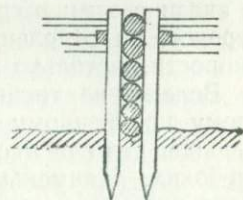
Поперечный разрез буна из кольев с фашинами или хворостом между ними.
